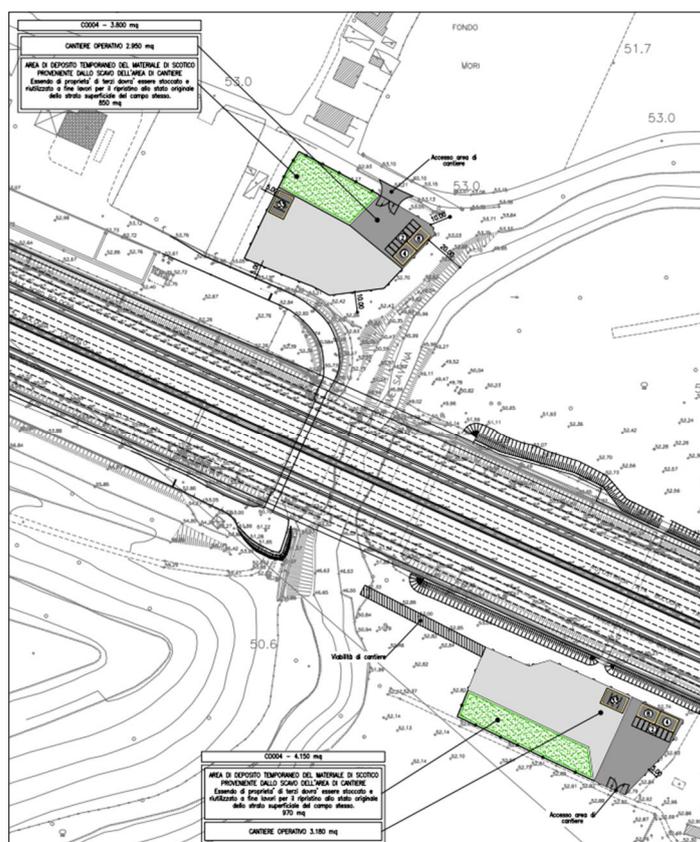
Layout dell'area di cantiere CO04 (stralcio da SIC5330)
